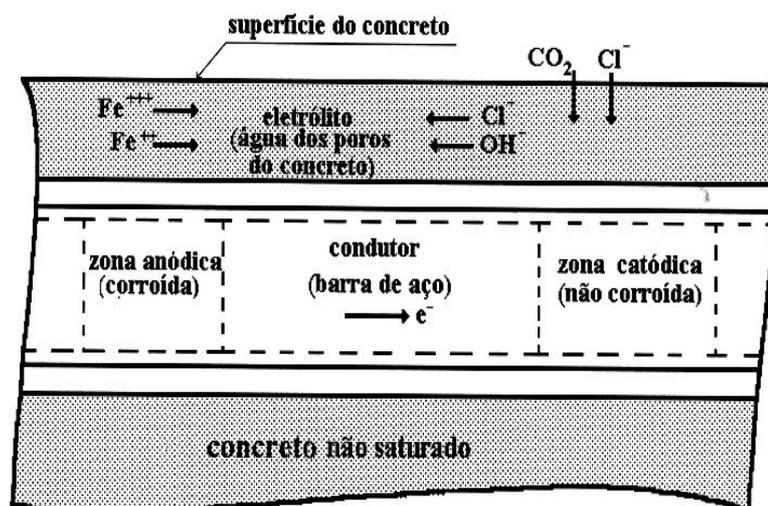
Célula de corrosão no meio do concreto armado (SOUZA; RIPPER, 1998).
